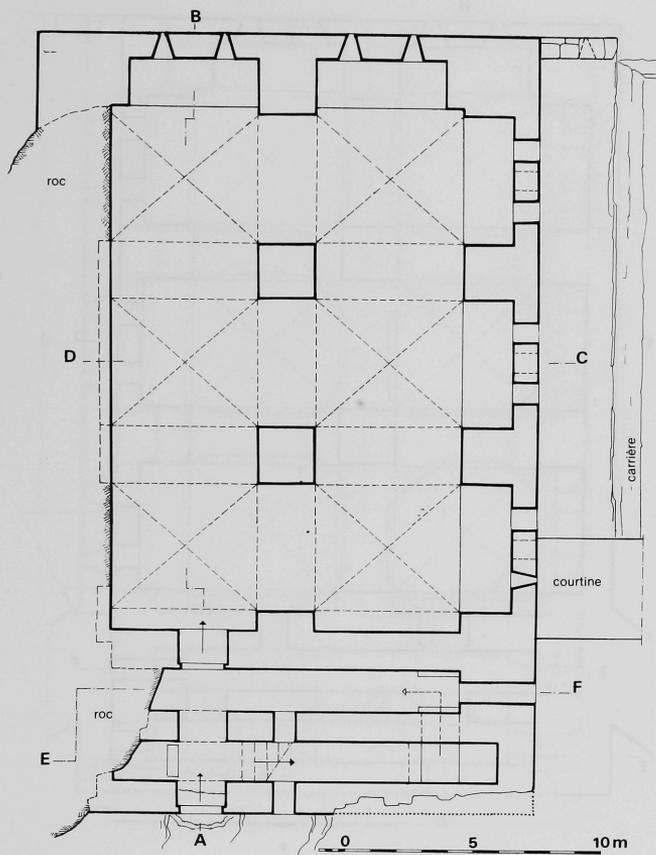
Le «Prétoire» 33, plan du rez-de-chaussée (niveau XY).
